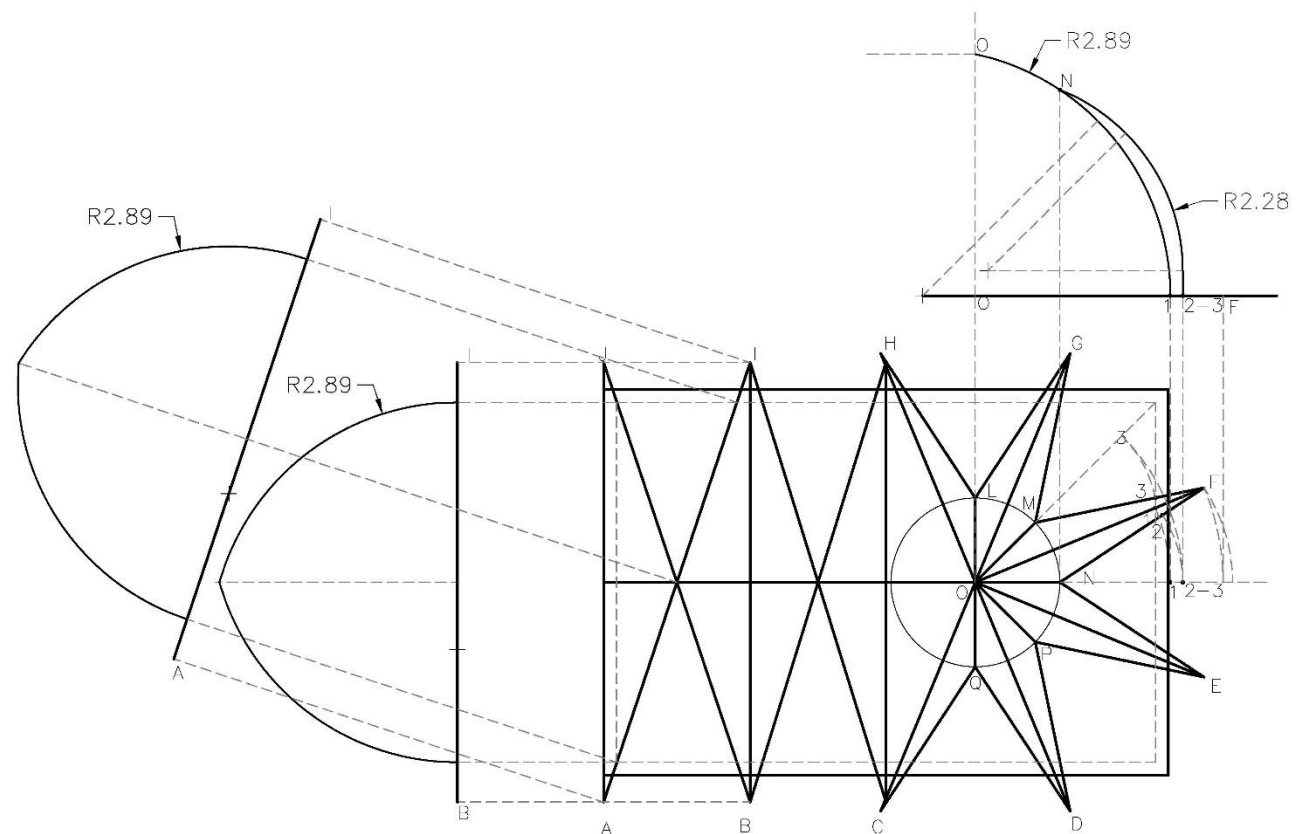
Propuesta de traza en planta de la bóveda.
